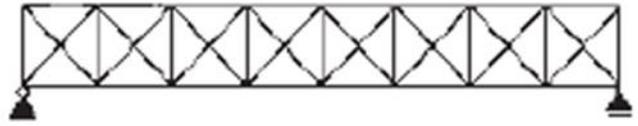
Poutre à treillis avec membrure parallèle (ABN Building Corporation.com)
